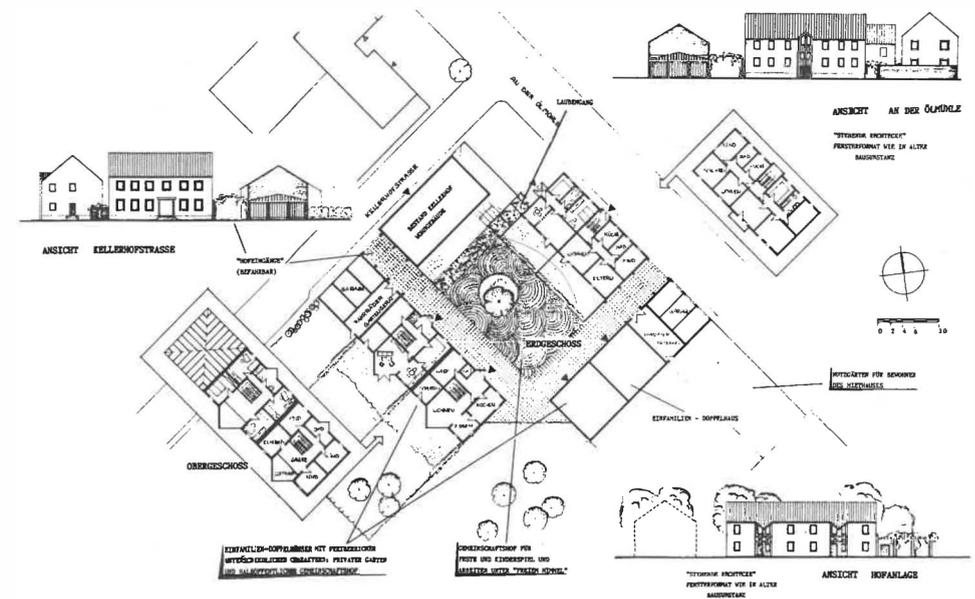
»Wohnhof Kellerhofstraße« – Grundrisse
